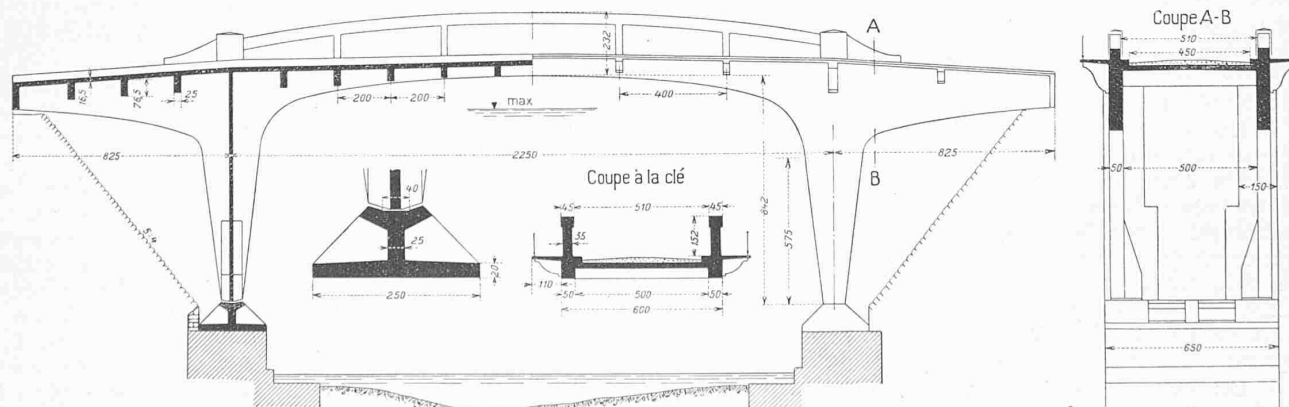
Elévation générale et coupes longitudinale, vers l'appui (A-B) et la clé, échelle 1 : 250. — Detail de l'articulation 1 : 100.
